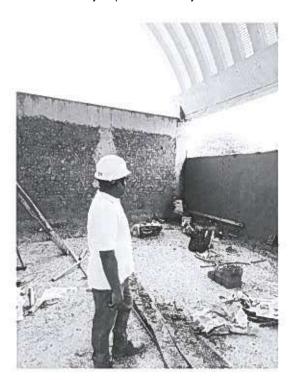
Se observa las fisuras en la losa aligera del primer nivel del bloque N.º 06.
